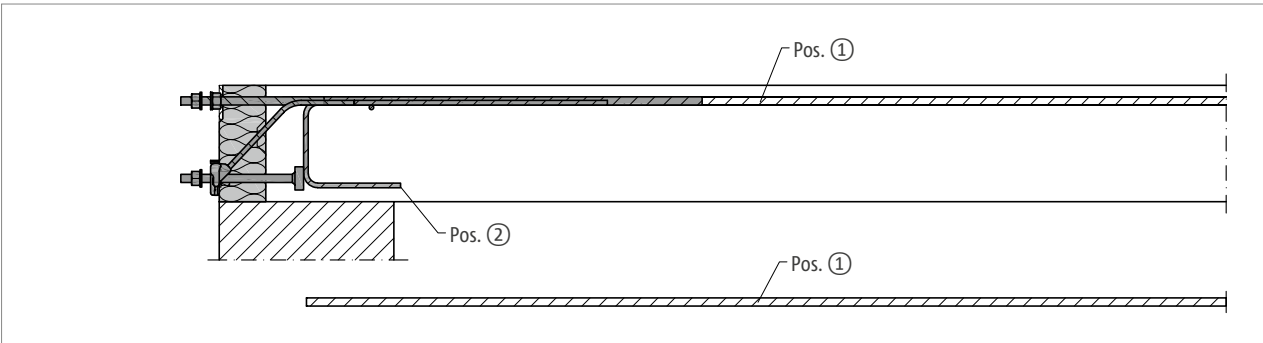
Schöck Isokorb® T Typ SKP-M1: Bauseitige Bewehrung, Schnitt
